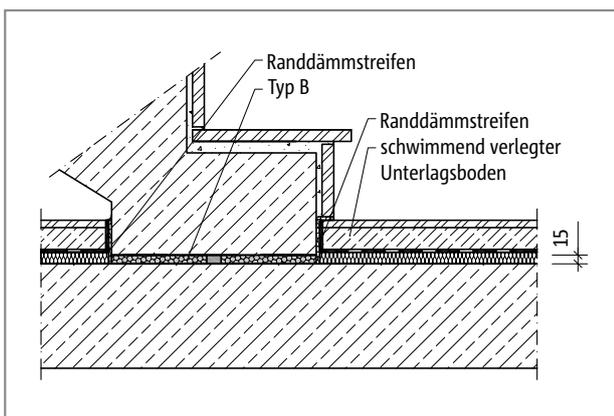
Schöck Tronsole® Typ B: Brandschutzausführung
